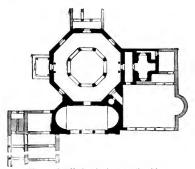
Baptisterium des Lateran, Grundriss,
